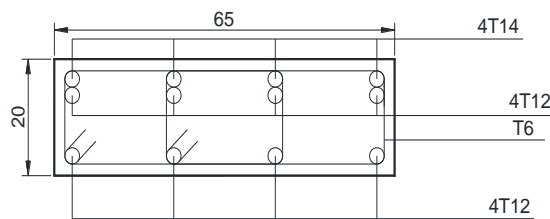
Coupe longitudinale d'une poutre noyée principale 65x20cm (plan légèrement irrégulier)
